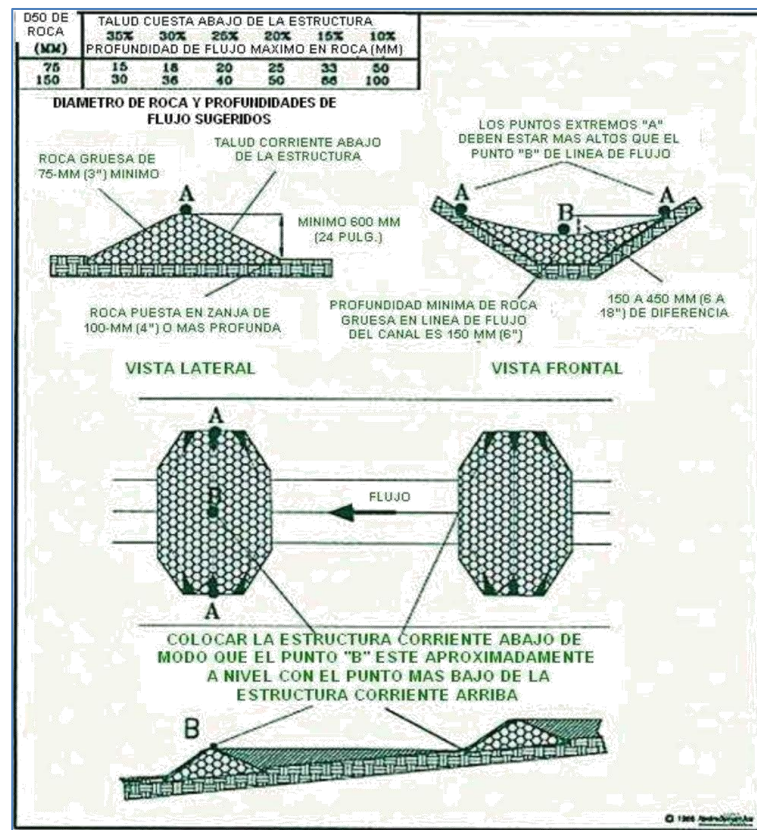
Ilustración de una estructura de retención de roca debidamente instalada
